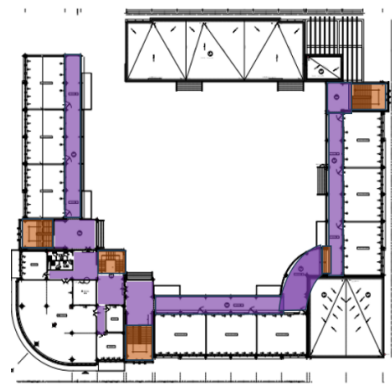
PLAN DU DEUXIEME ETAGE NIV ; +07.48 ECHELLE :1/50
